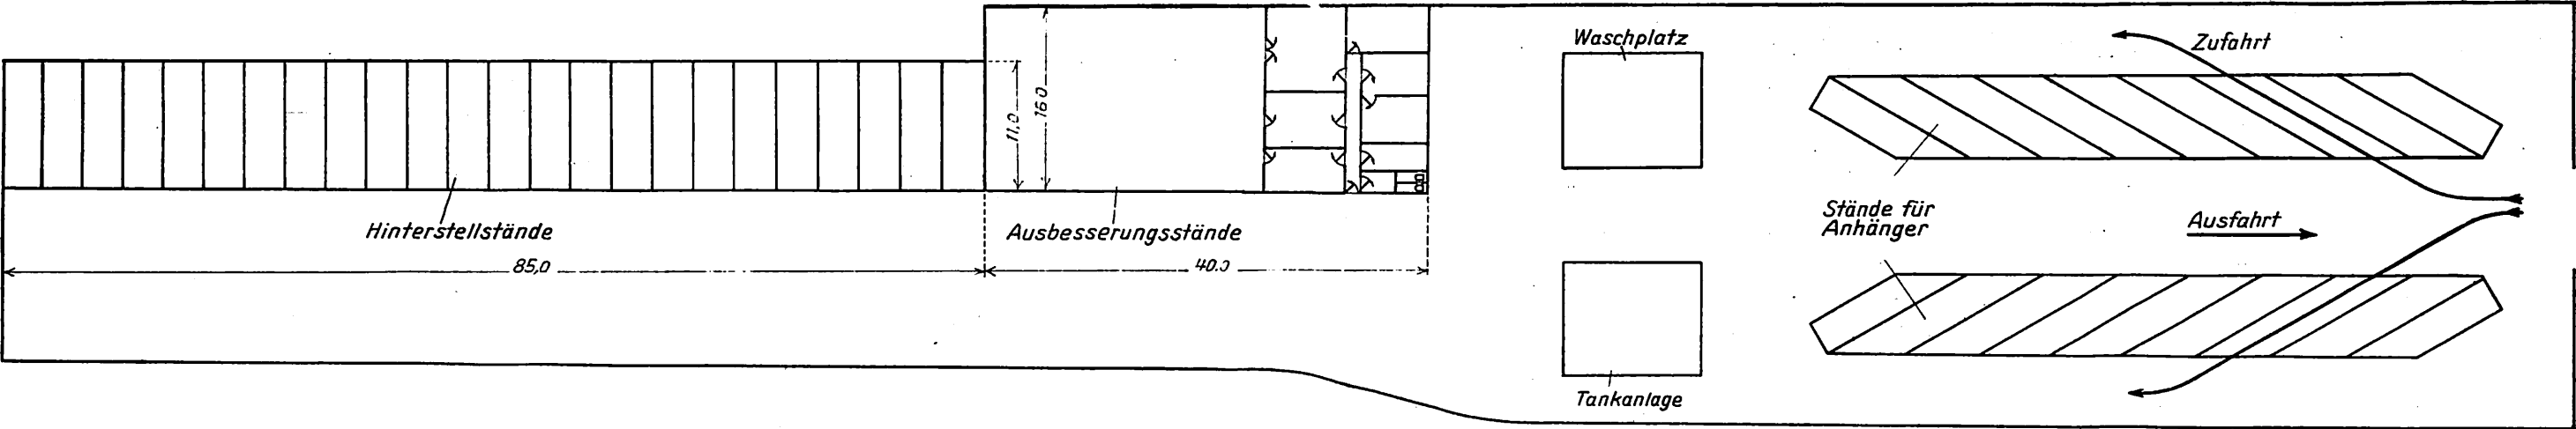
Grundriß einer Anlage für vorerst 24 Wagen mit aneinandergereihten Einzelständen.
